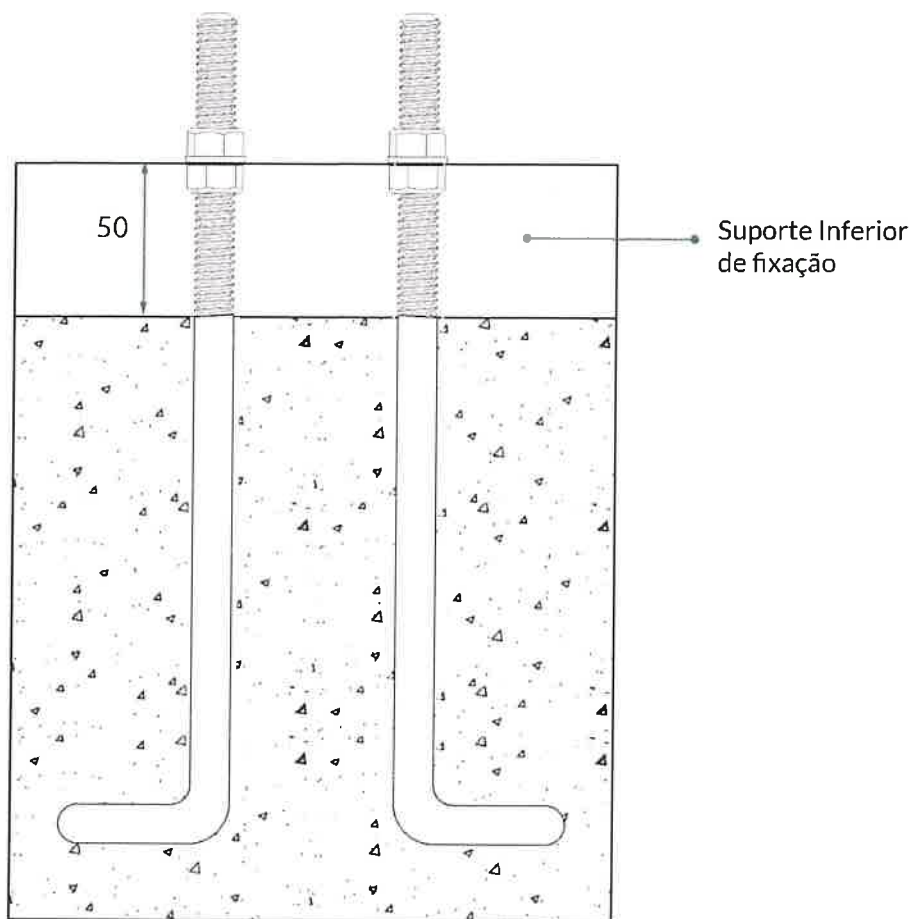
Montagem das hastas de fixação com o suporte inferior de fixação.
